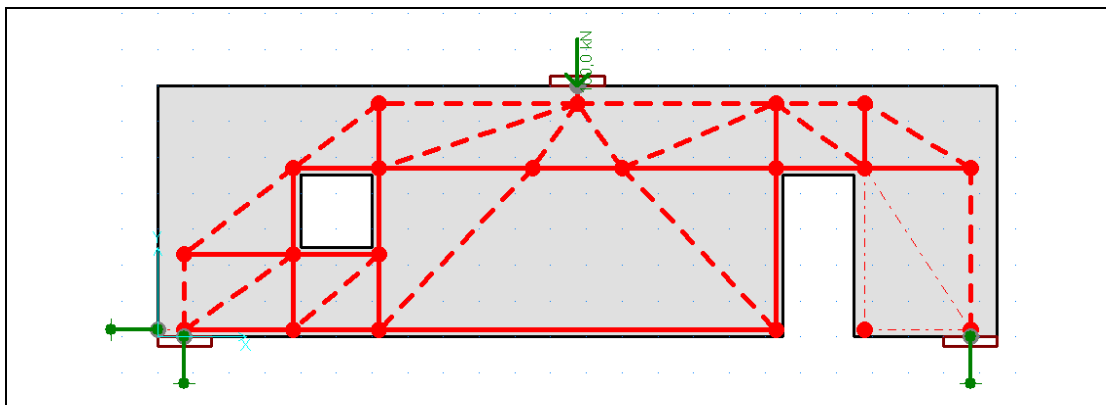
“Modelo B”, constituído apenas de tirantes horizontais e verticais
